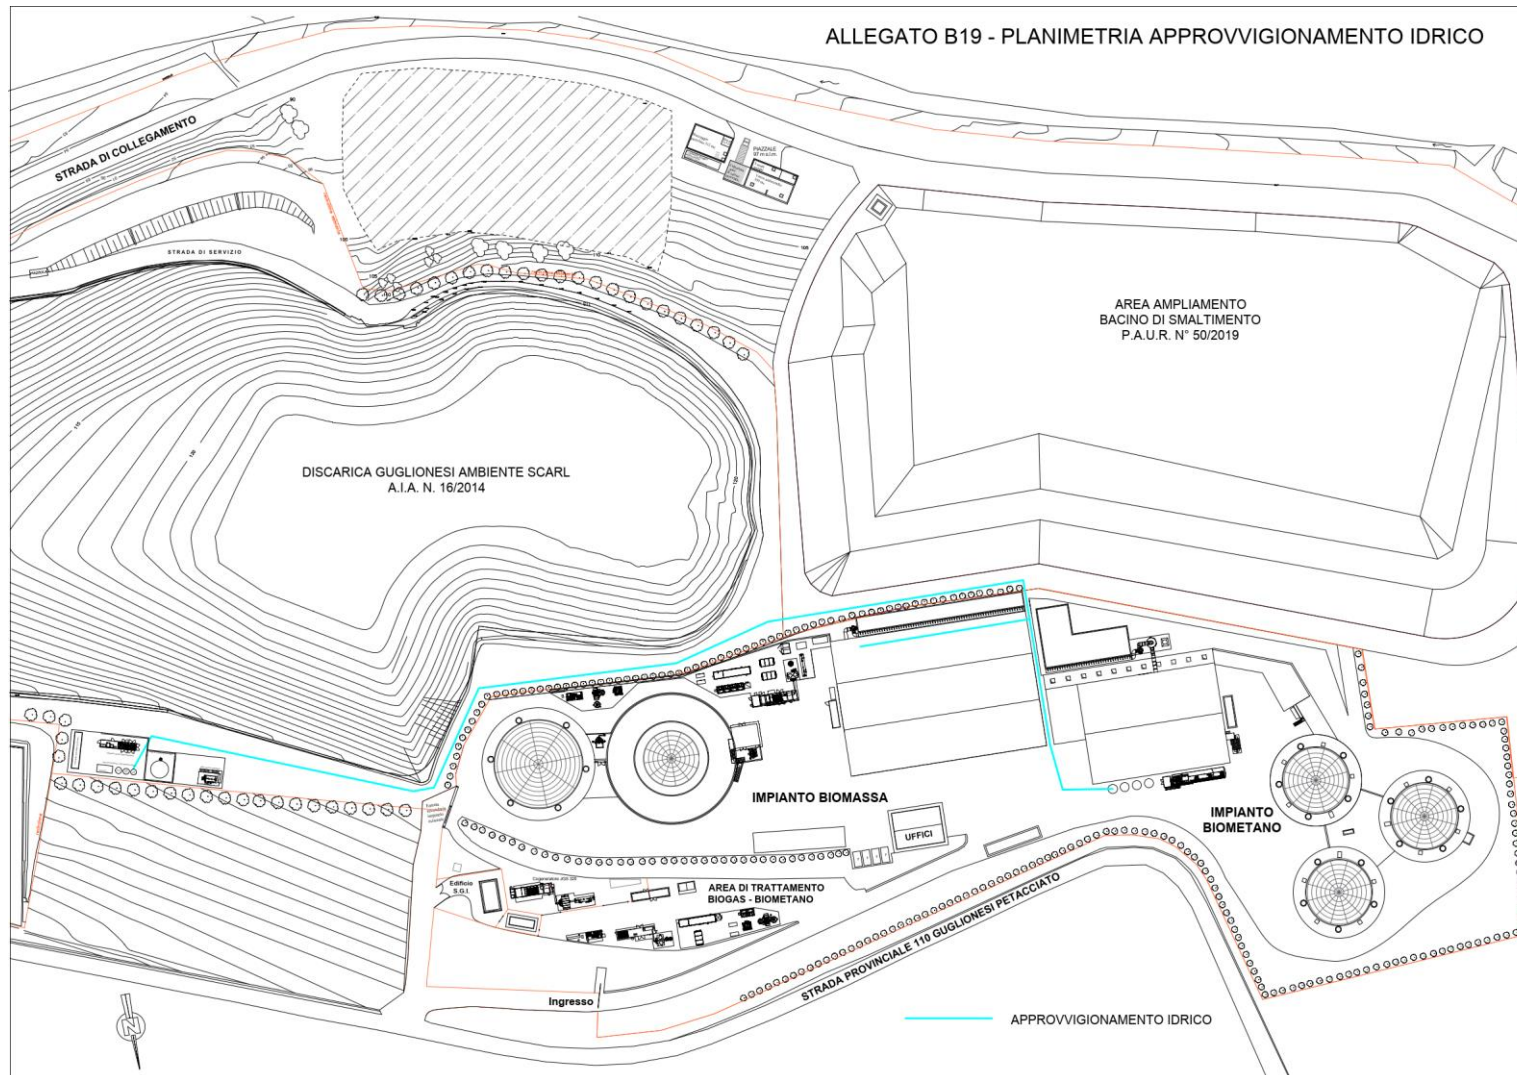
planimetria generale di stabilimento con indicazione dell'approvvigionamento e distribuzione idrica
